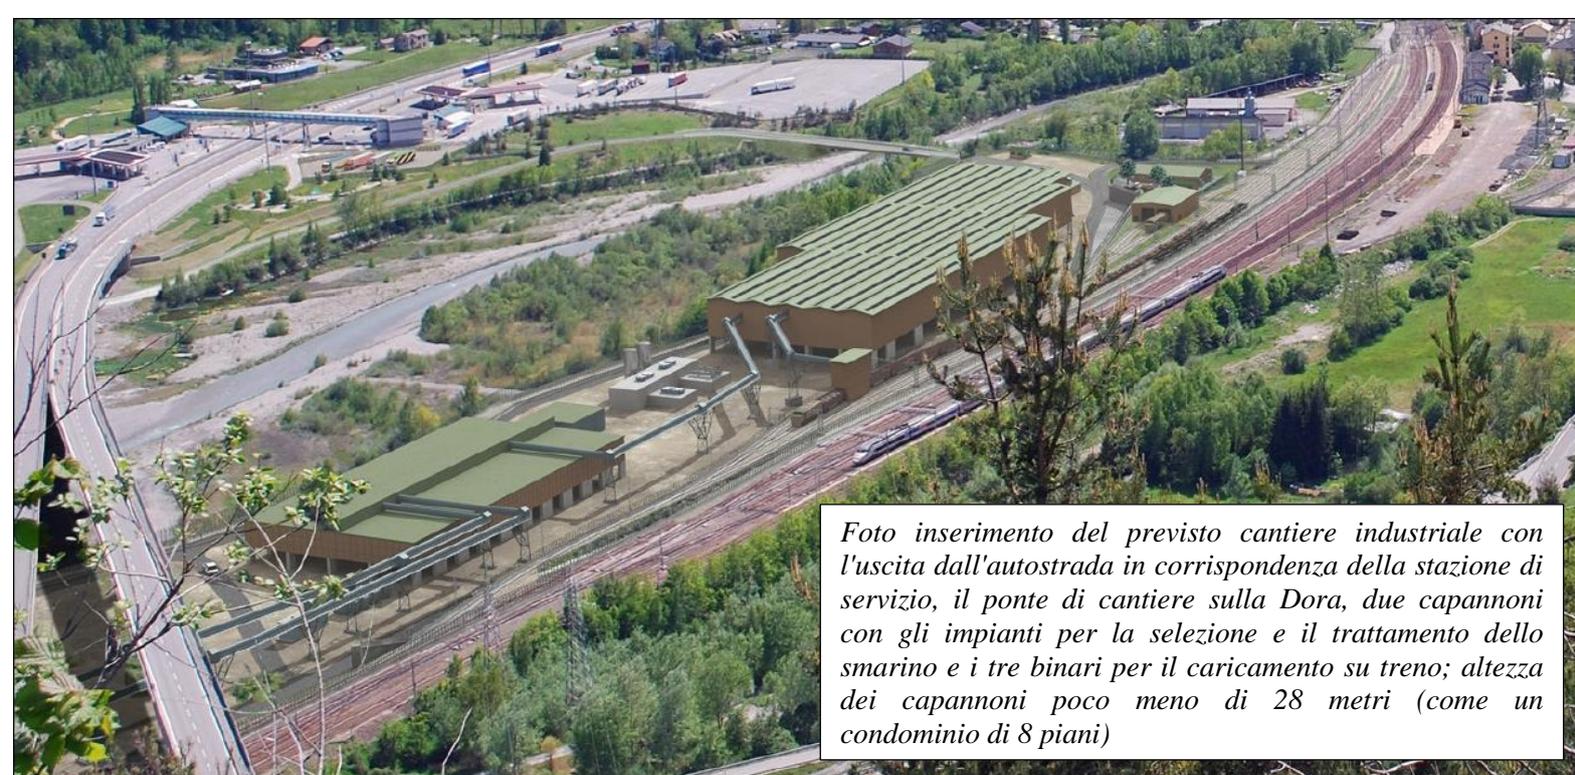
Layout di cantiere - Area industriale di Salbertrand
